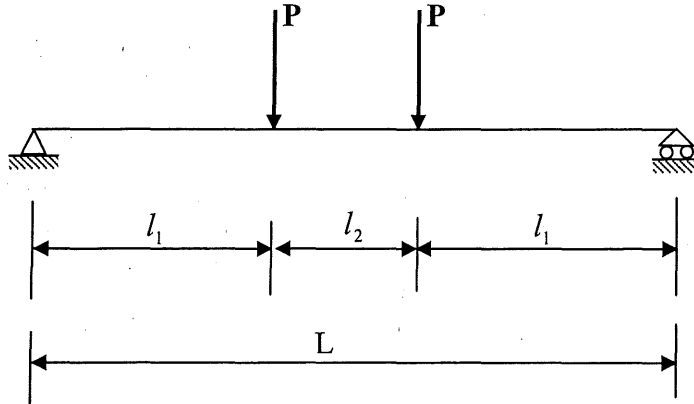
Schéma statique d'une dalle renforcée en PRF
